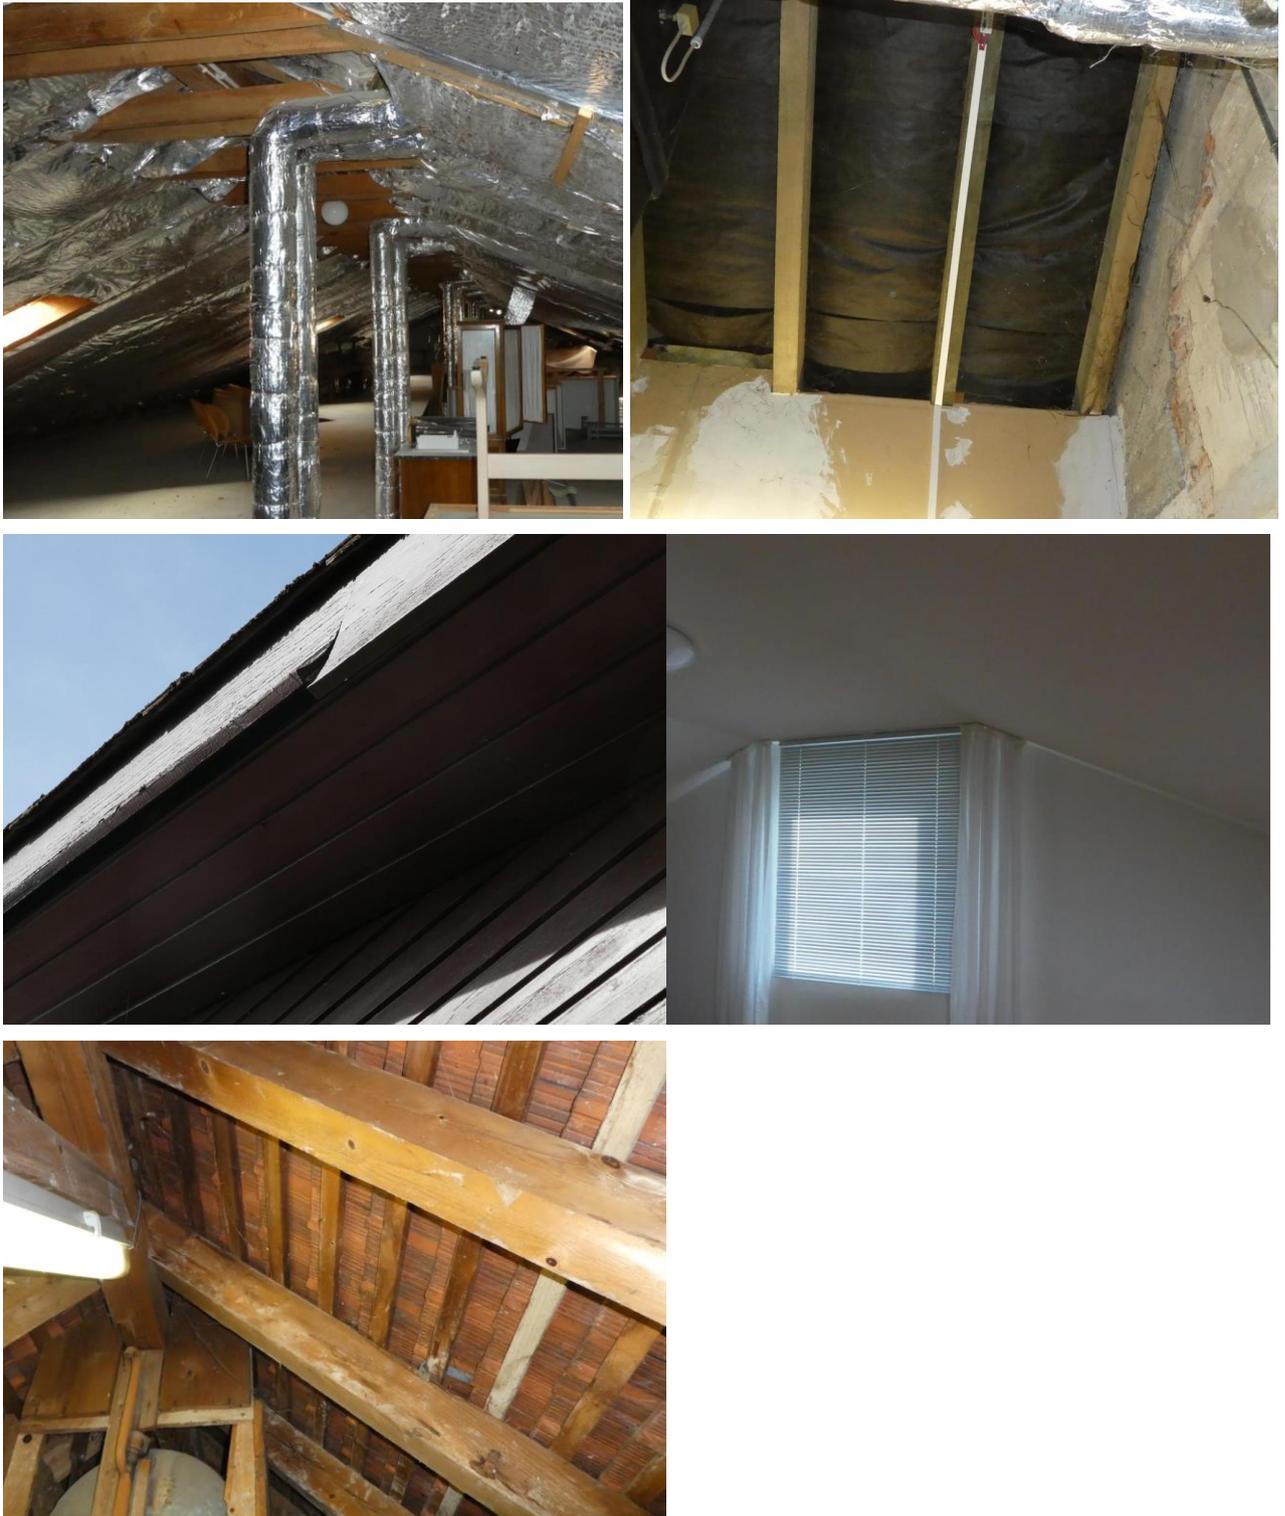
Gebäude- und Dachstrukturen der Abrissbauwerke (Quelle: Kunz GaLaPlan 2023).
